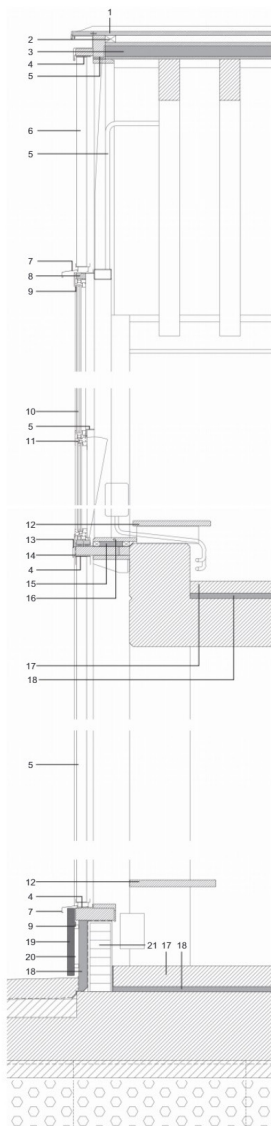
Detalle constructivo drenajes perimetrales nuevas construcciones
